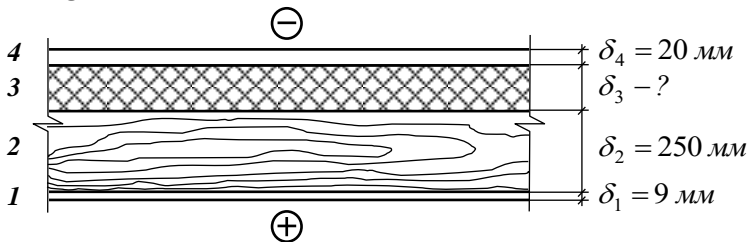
Розрахункова схема конструкції горіщного перекриття (переріз 1-1)
